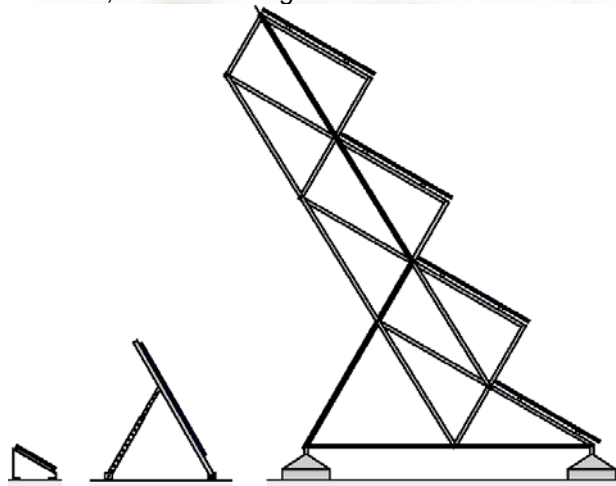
Sistema de montagem em telhados planos com várias alturas de construção
